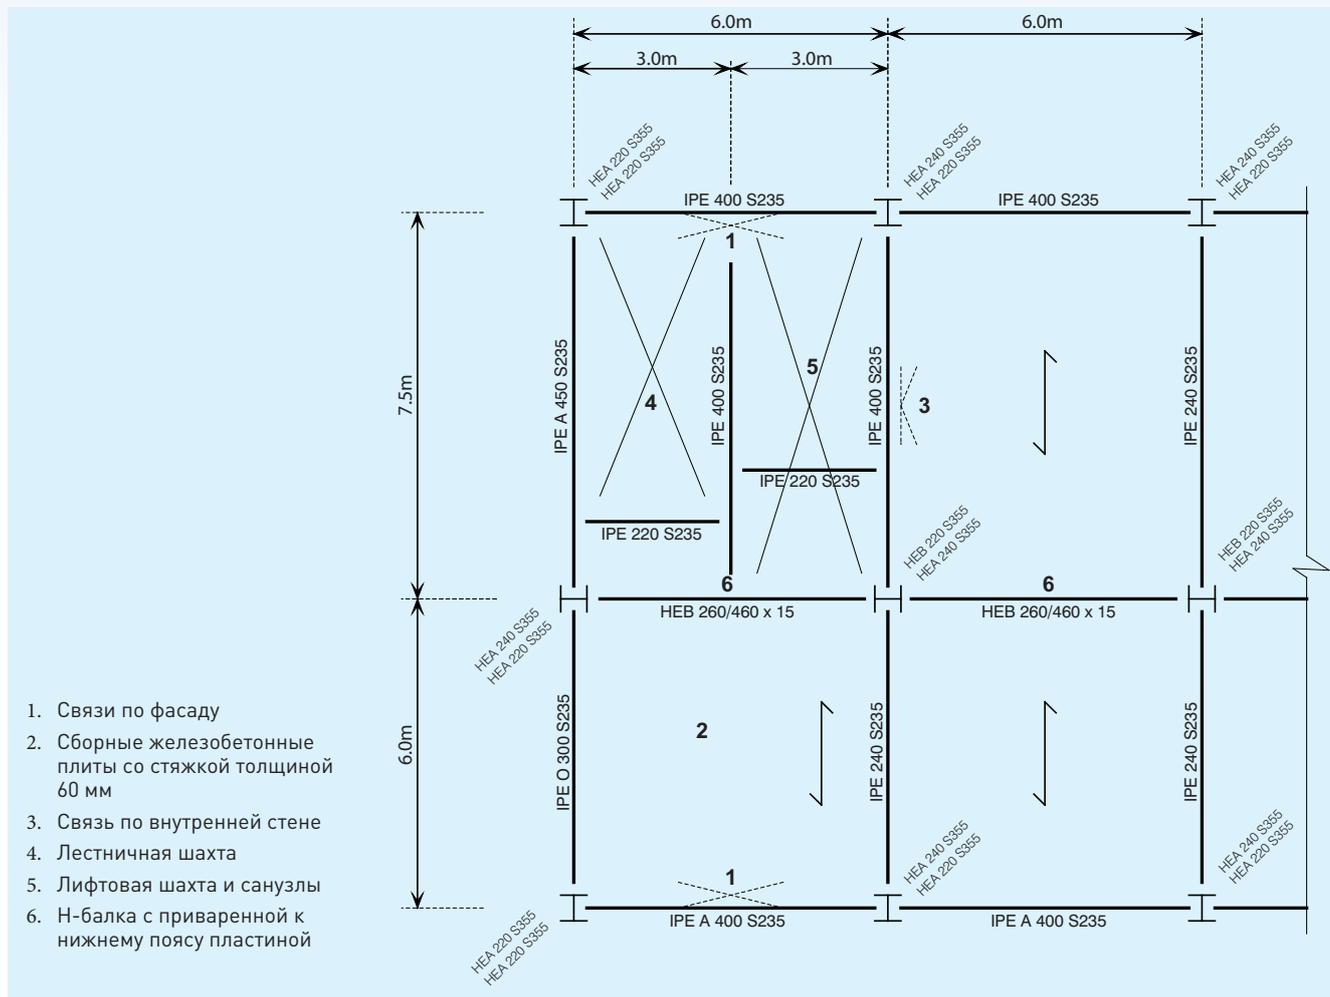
Конструктивная схема 4-этажного прямоугольного здания (центральная балка – стальной профиль Н с приваренной к нижнему поясу пластиной, крайние балки расположены под сборными плитами)
